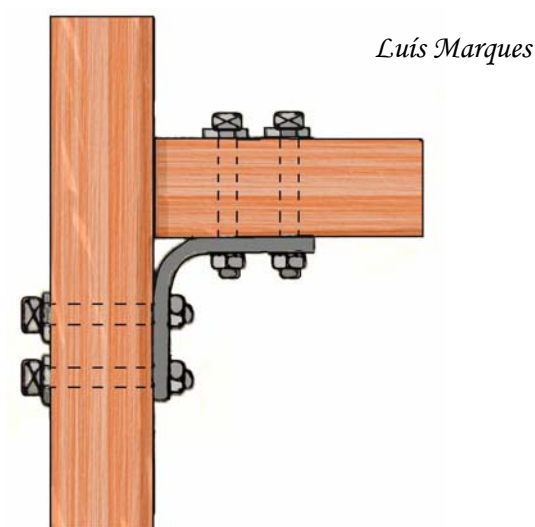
Reforço de ligação com recurso a cantoneira metálica
